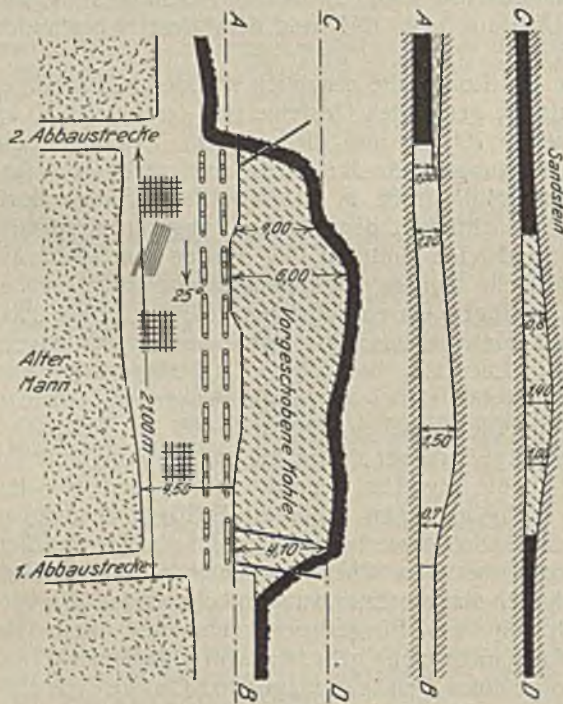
Ausbruch (Kohlenvorschub) vom 18. Oktober 1906 im Flöz Oodinette des Kohlenbeckens von Borinage¹.
